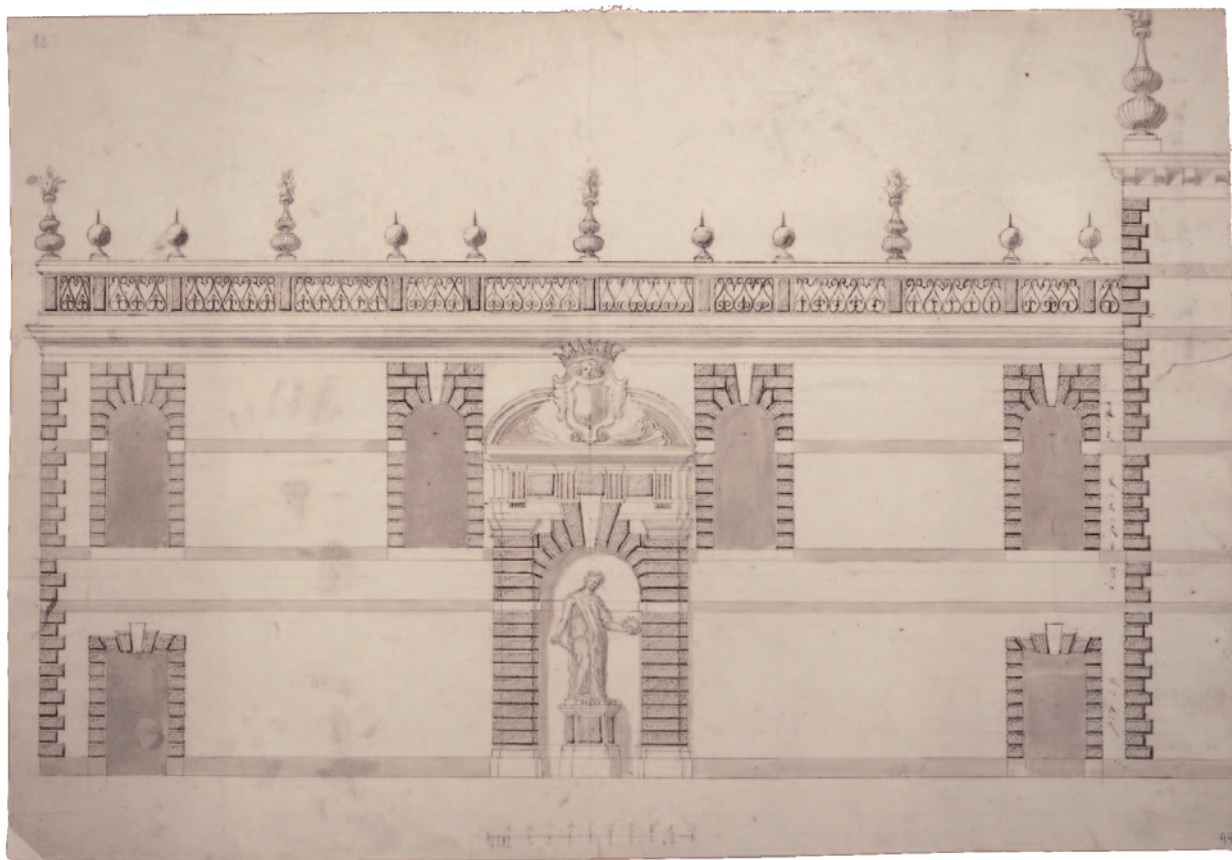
Antonio Gaspari, prospetto della libreria di palazzo Zane (Fondazione Musei Civici di Venezia, Gabinetto dei disegni e delle stampe, Raccolta Gaspari, I, 92.).
